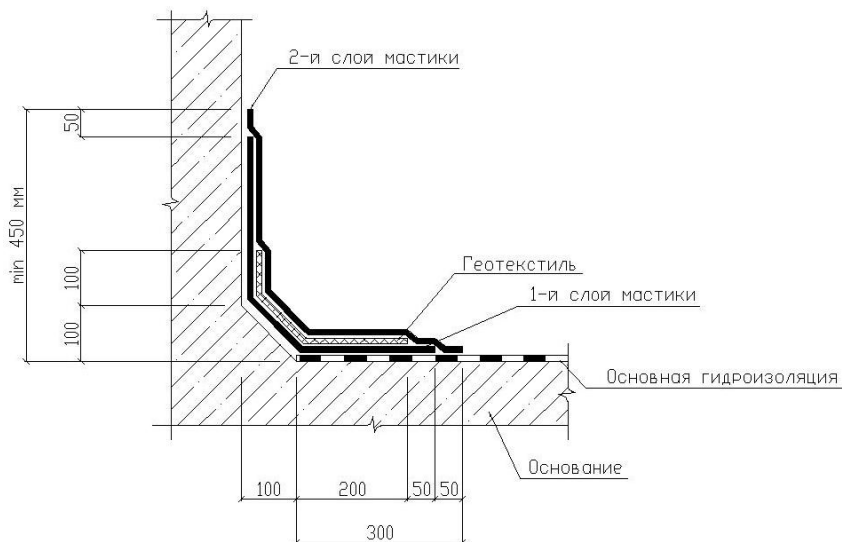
Устройство гидроизоляции примыкания к вертикальной поверхности. Вариант без армирования вертикальной поверхности.
